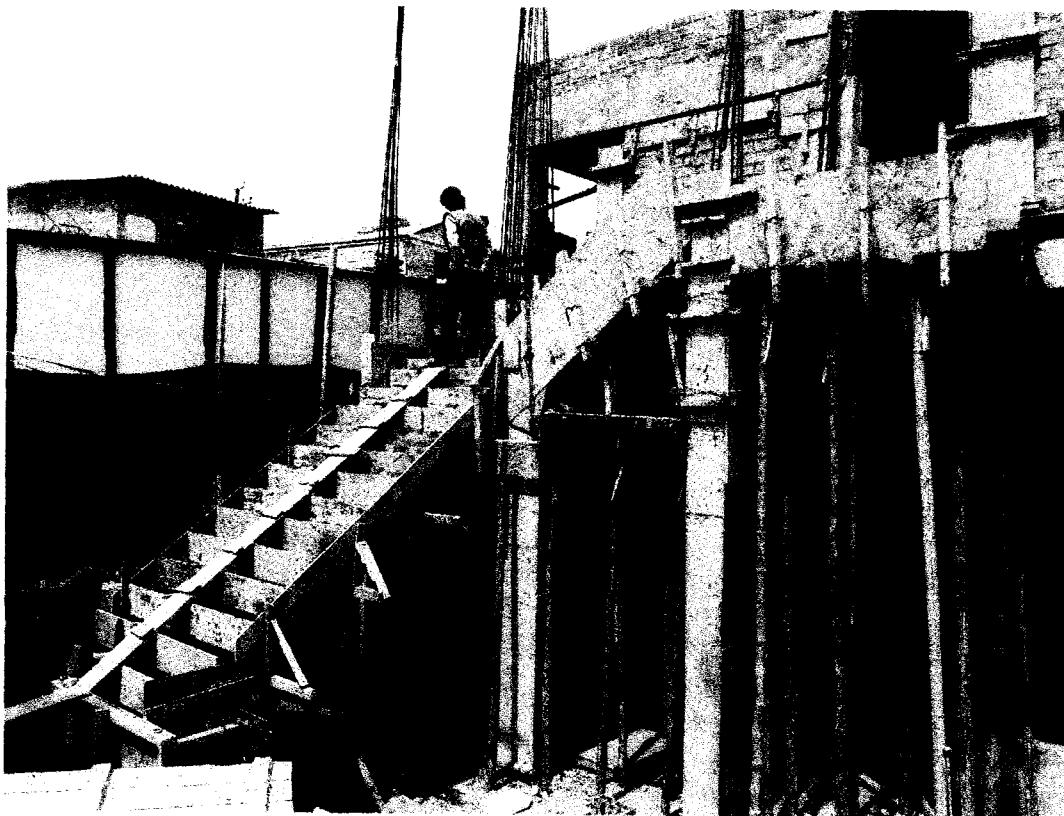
Encofrado y colocado de acero en escalera de administración.
